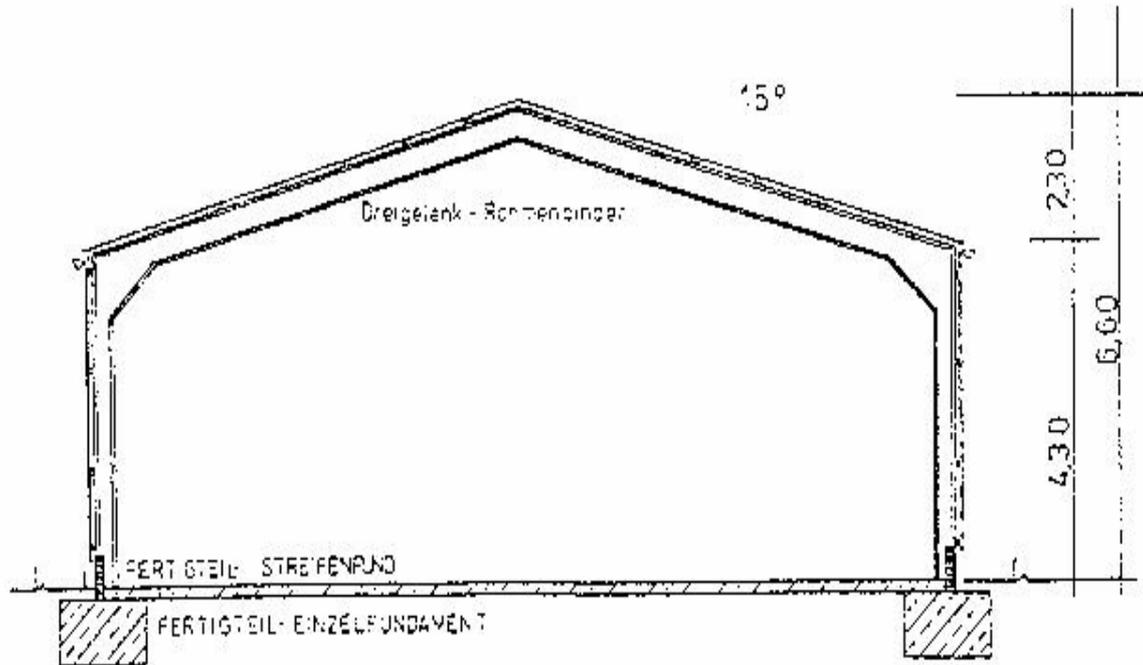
Stahlrahmen-Konstruktion (Werkbild: Landbau Schwarz)
